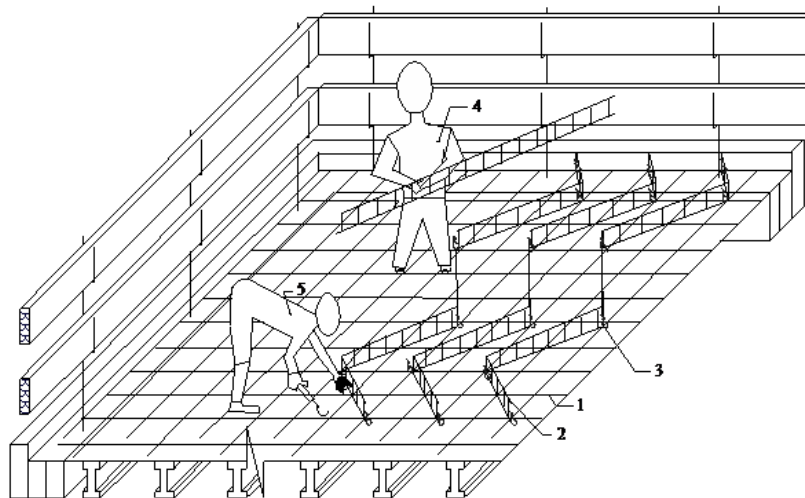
Установка поддерживающих каркасов: 1 стержни арматурной сетки; 2 поддерживающий каркас; 3 закрепление поддерживающего каркаса к арматурной сетке вязальной проволокой; 4 рабочий устанавливающий каркас; 5 рабочий закрепляющий каркас
